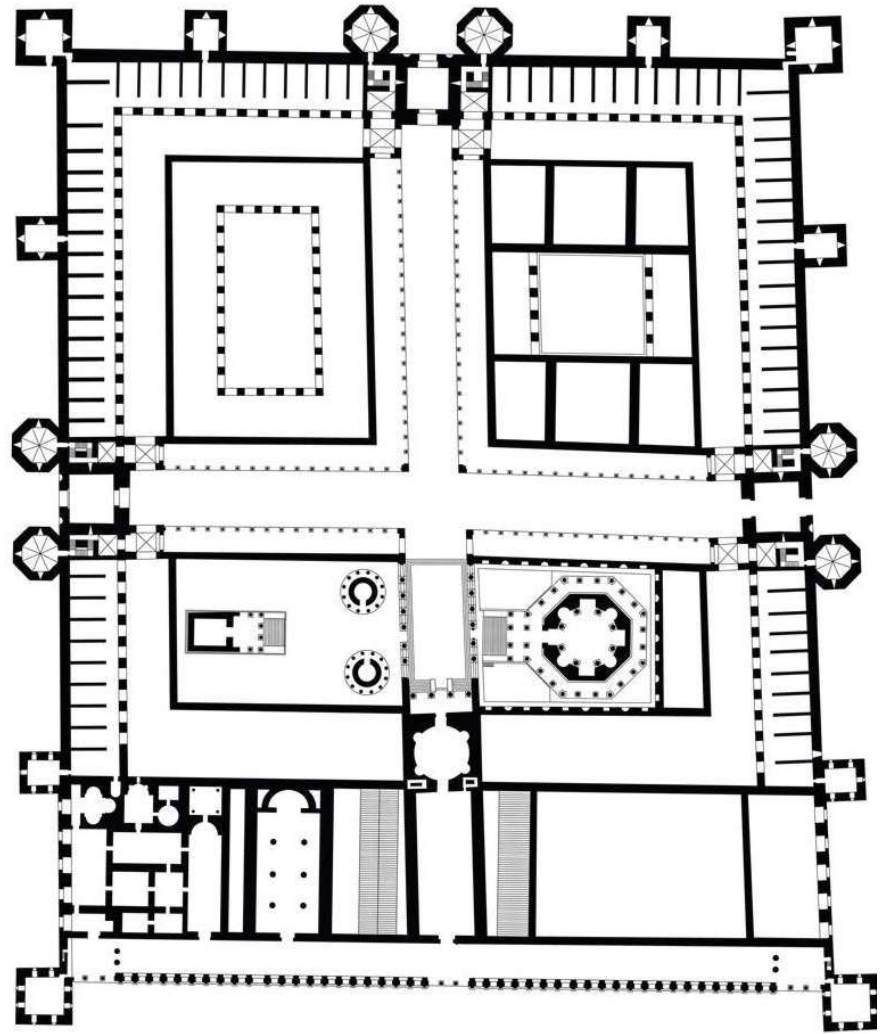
Grundriss Diokletianspalast 300 n. Chr., ETH Zürich, Studio Adam Caruso, Edited by Alex
